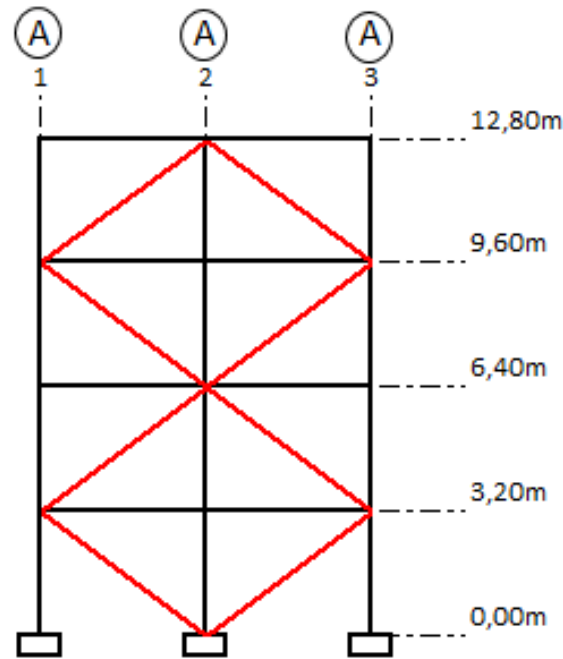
Fachada lateral izquierda y derecha, edificación con arriostramiento.
